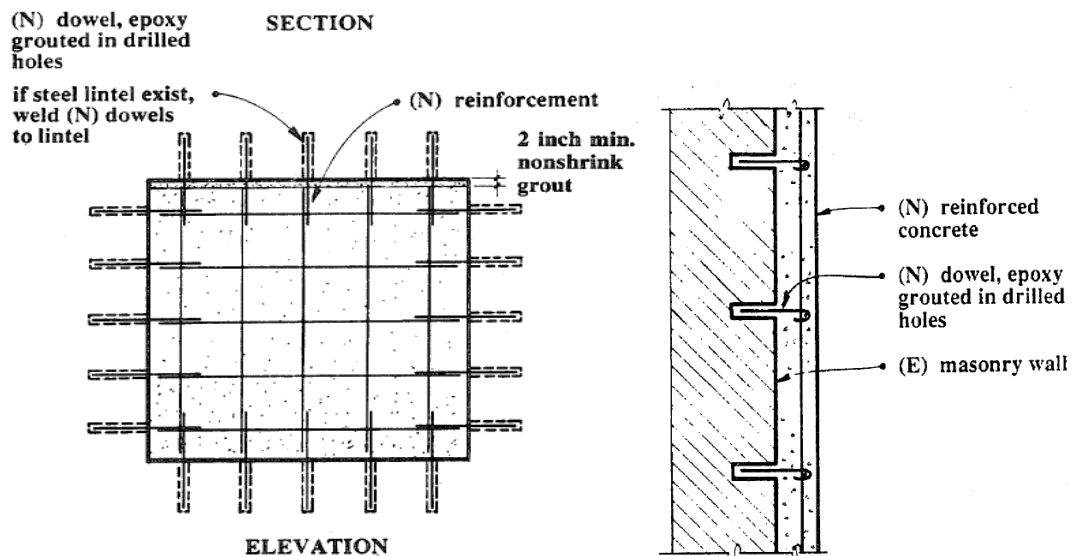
Detalle en alzado y corte del reforzamiento de un muro existente, mediante recalce con concreto reforzado. Fuente: FEDERAL EMERGENCY MANAGEMENT AGENCY - FEMA. *Techniques for the Seismic Rehabilitation of Existing Buildings*. U.S.A.: El Autor, 1992.
